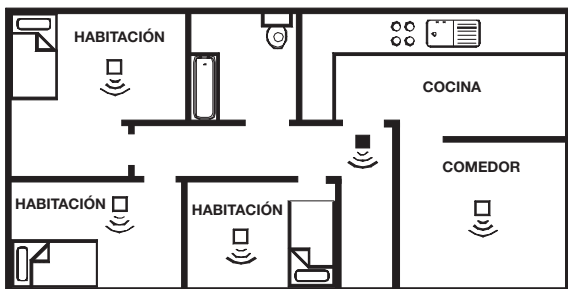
Vivienda de una sola planta con zonas de dormitorios independientes
